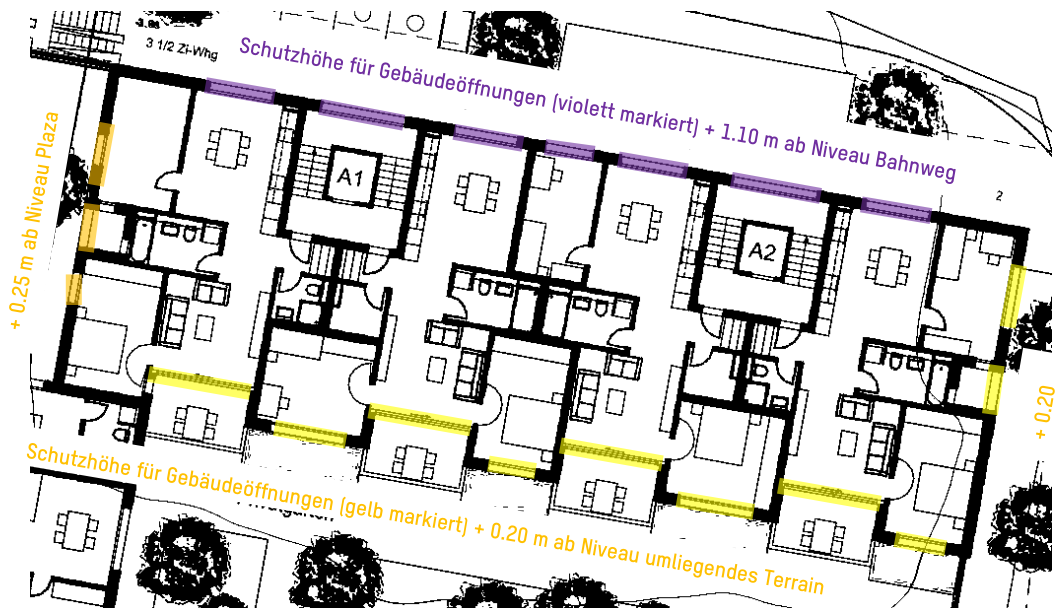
Planausschnitt Massnahmenbereich Erdgeschoss Gebäude A. Die von Hochwasser betroffenen Gebäudeöffnungen sind mit der einzuhaltenden Schutzhöhe in orange, gelb und violett dargestellt.
